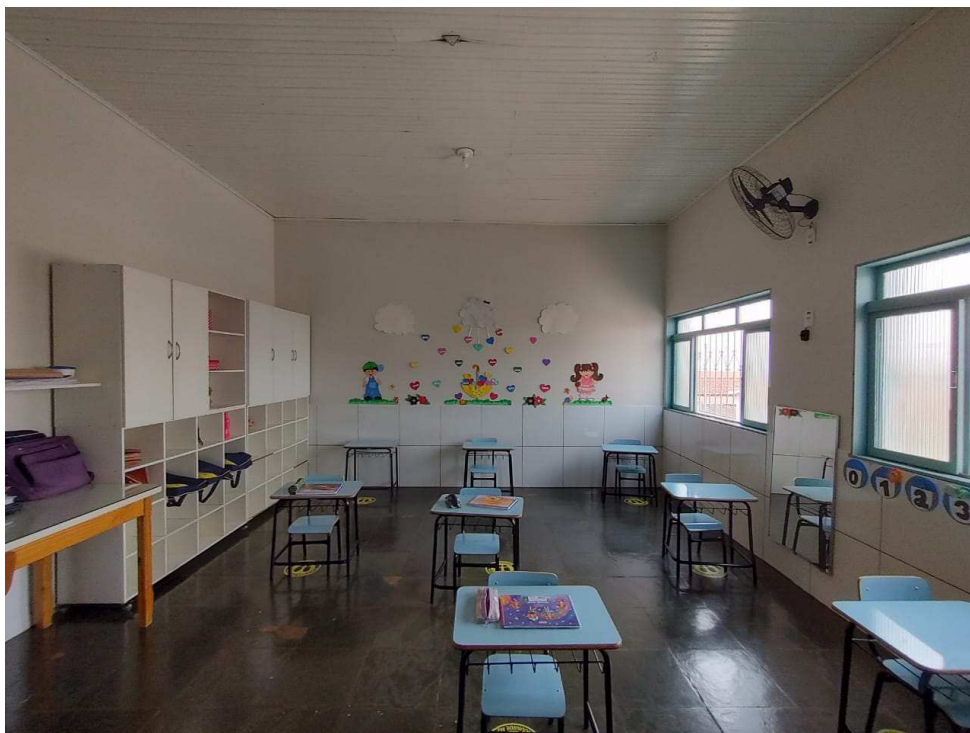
(Sala onde será substituído forro e instalado novo piso);
